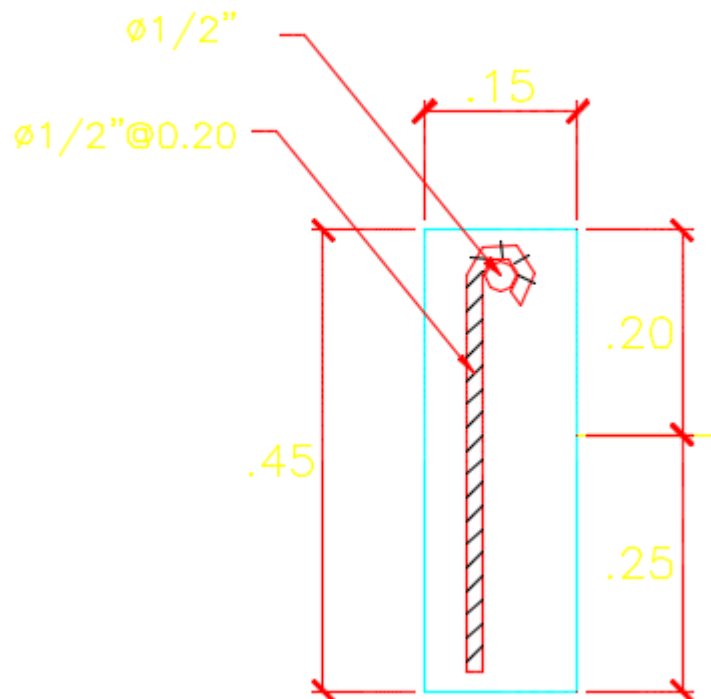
Dimensión 5 (Estructura del Pavimento)
